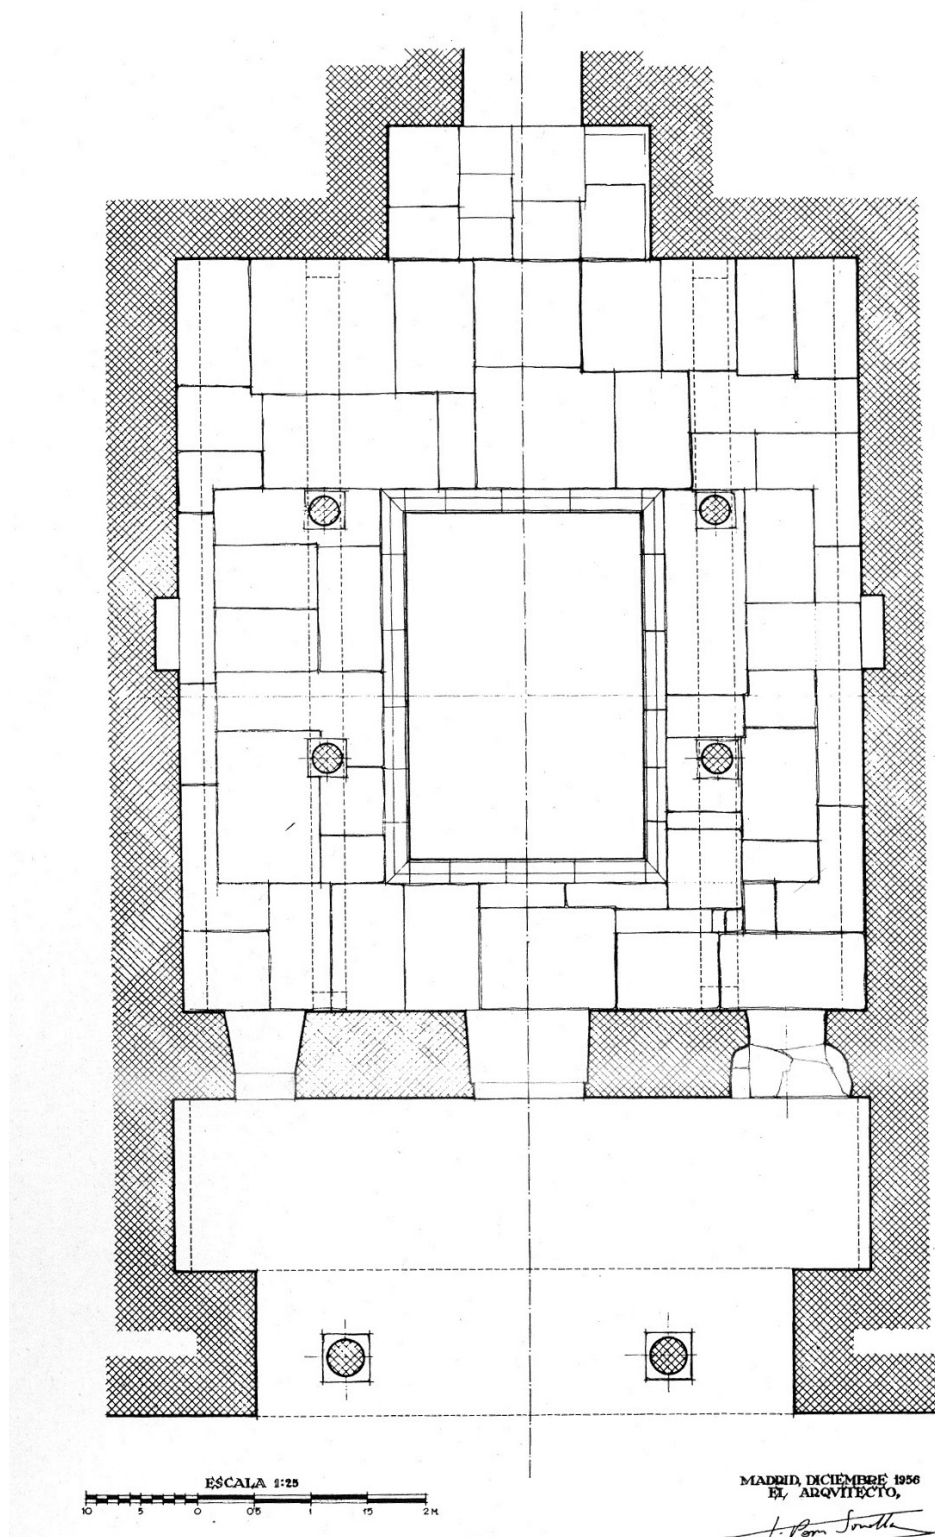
Santa Eulalia de Bóveda. Planta con piscina reconstruida. Ministerio de Cultura
